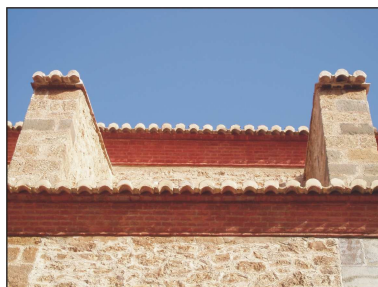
Detalle de la parte central de la fachada de la Iglesia después de la restauración.
